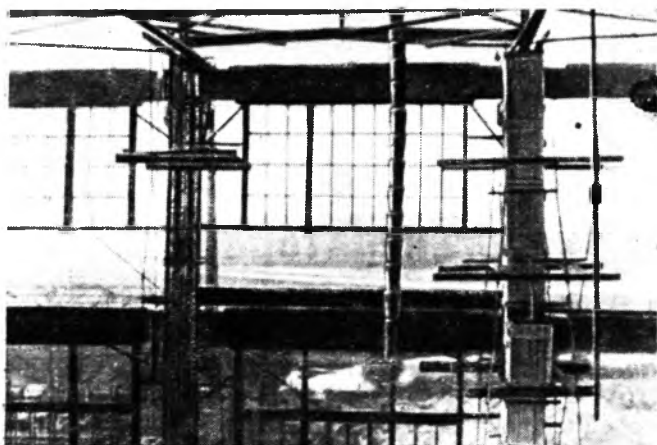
Фасадная стена машинного отделения. Стойки с несущим арматурным каркасом; обвязочные балки — сборные.
